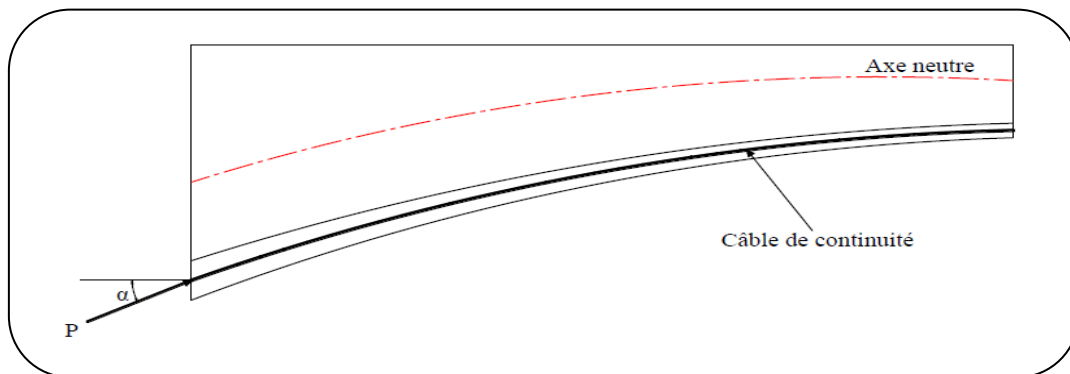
Effort tranchant dans une section de poutre en béton précontraint.
